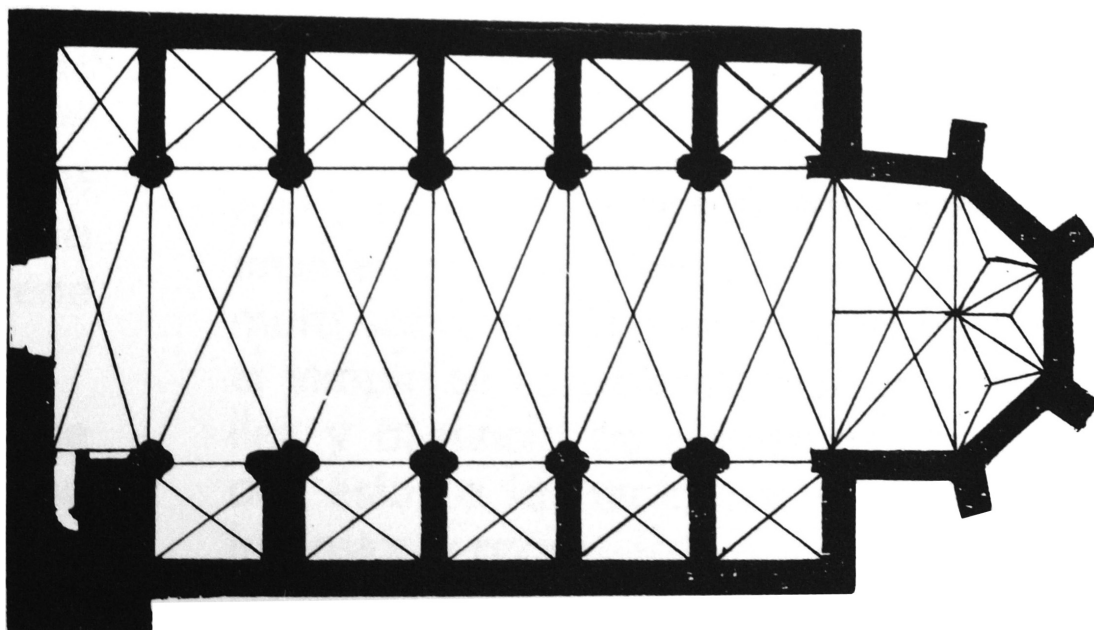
Planta de la primitiva iglesia de Santa María de Alicante. Autor: M. Bevià.
